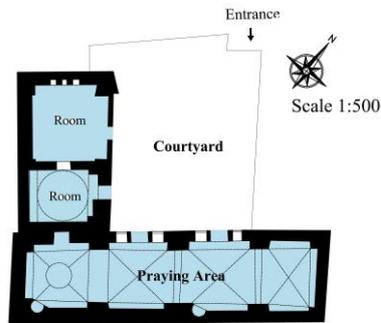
مسقط أفقي مسجد كاتب ولاية
